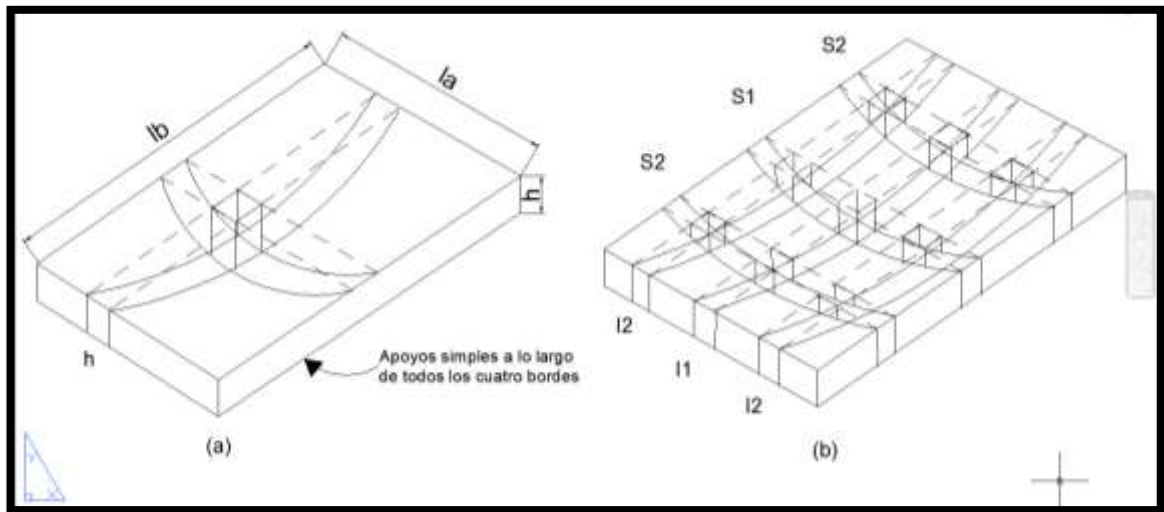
Losa en dos direcciones sobre apoyos de bordes simples: (a) flexión de la franja central de la losa; (b) modelo reticular de la losa
